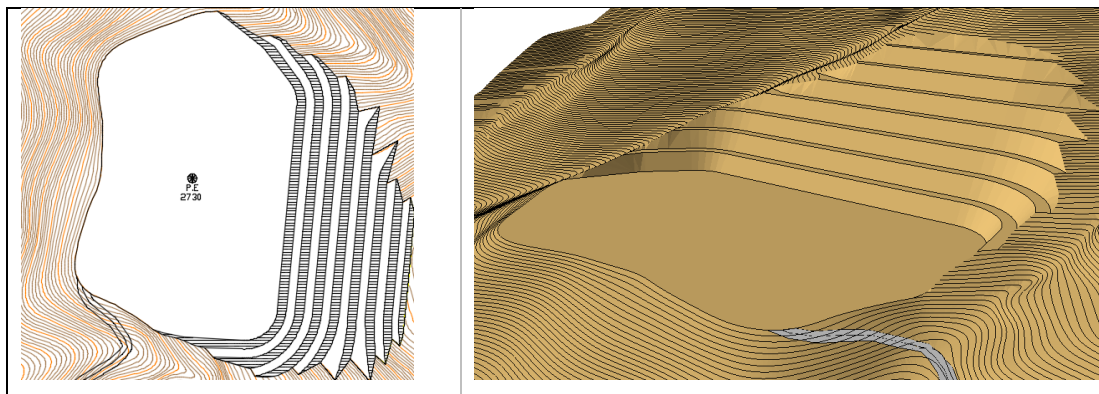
Vista en planta y en 3D de la Fase 8 de explotación.
